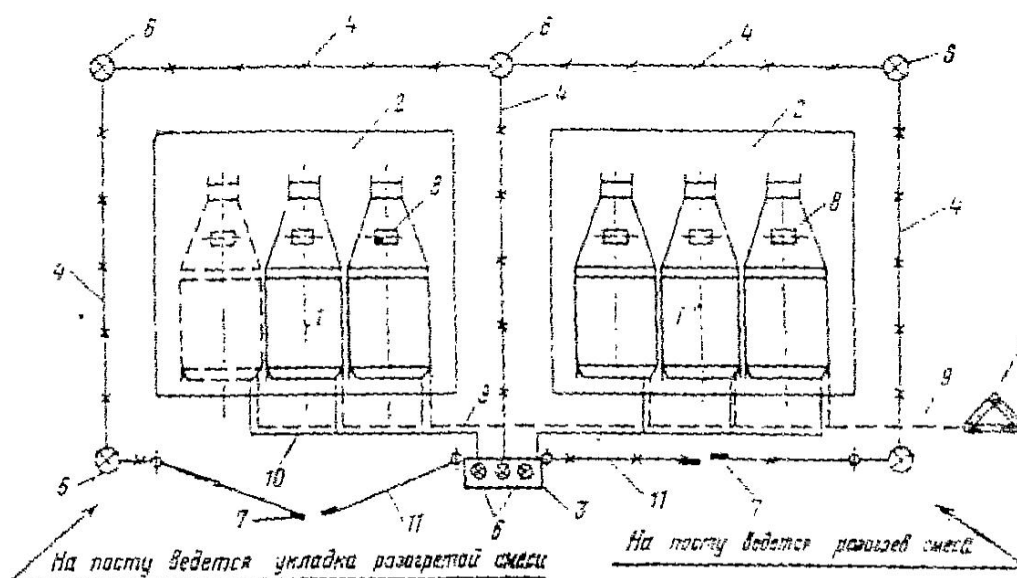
Принципиальная схема площадки для разогрева бетонной смеси
